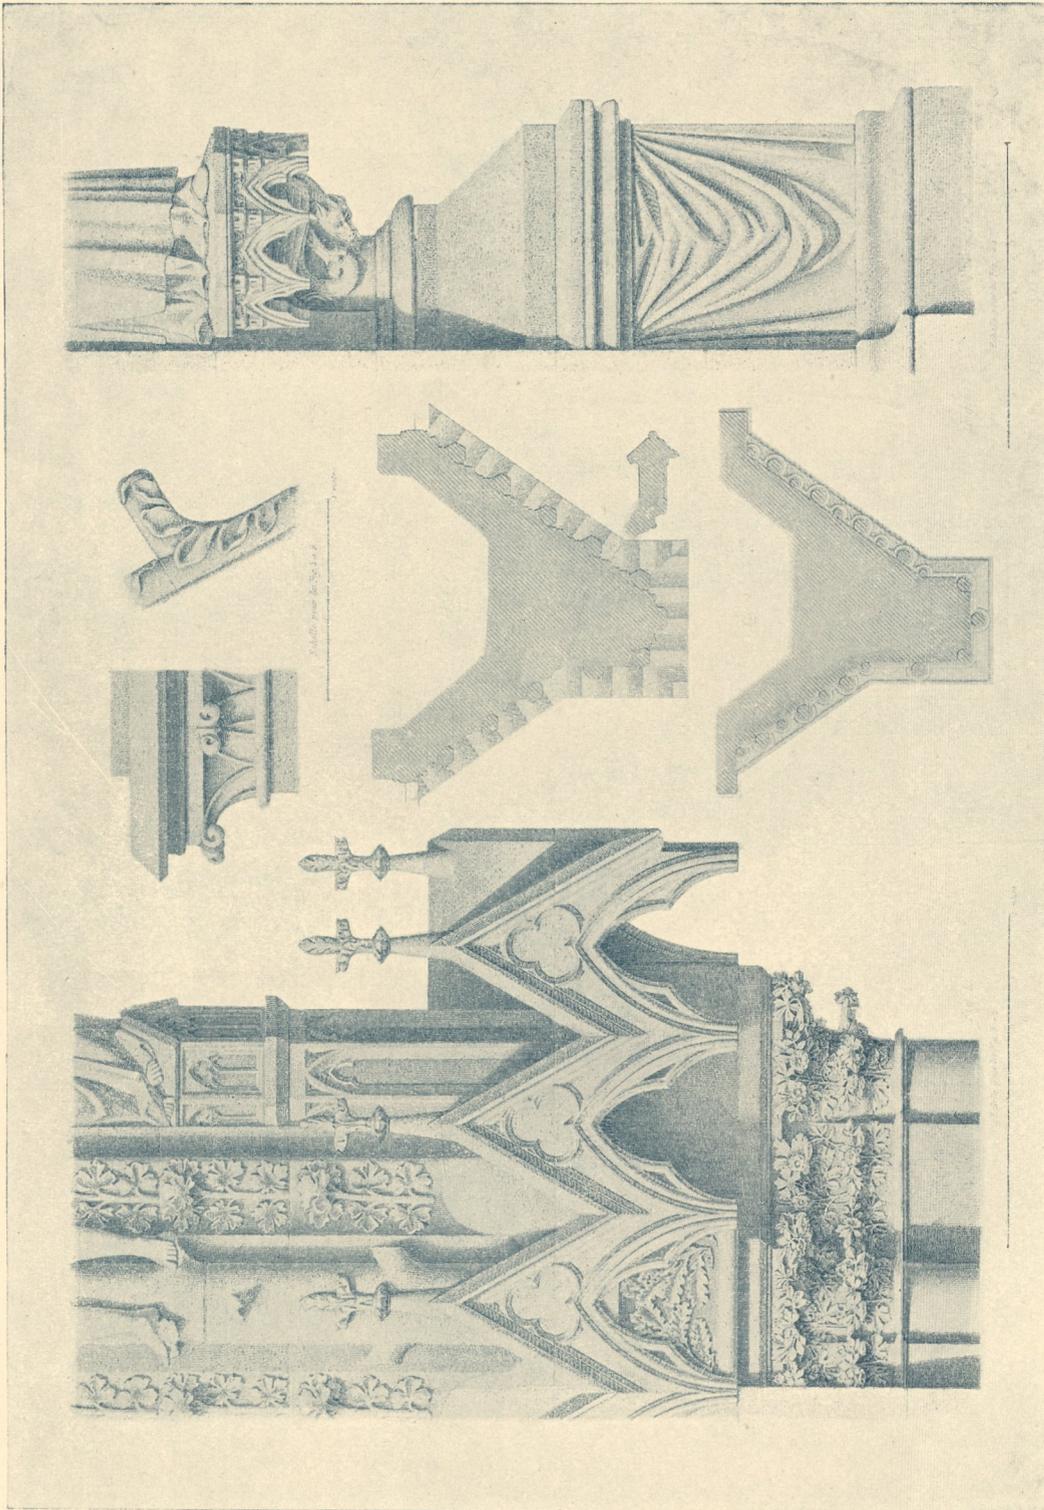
Kathedrale zu Reims. Façade. — Details der Vorhalle.
